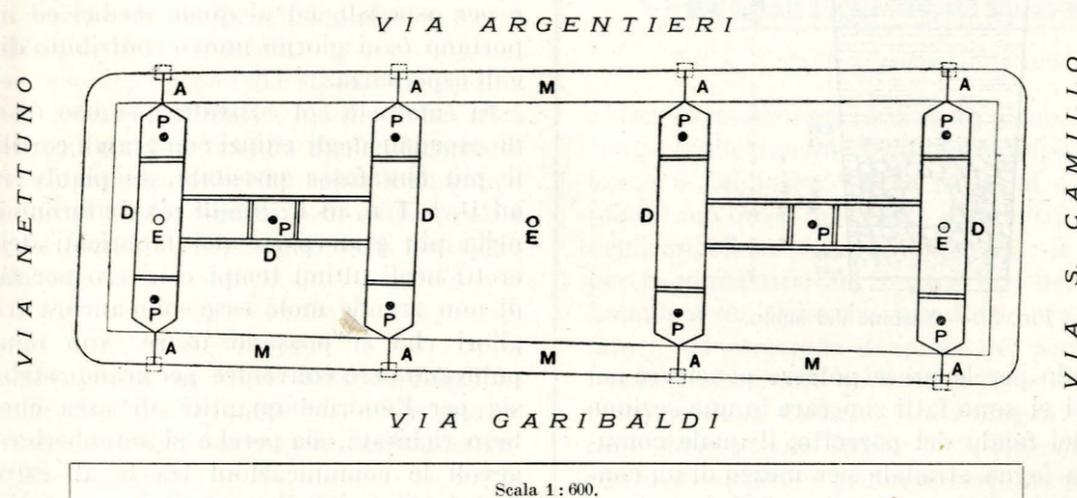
Piazza del Municipio colla planimetria del drenaggio.
